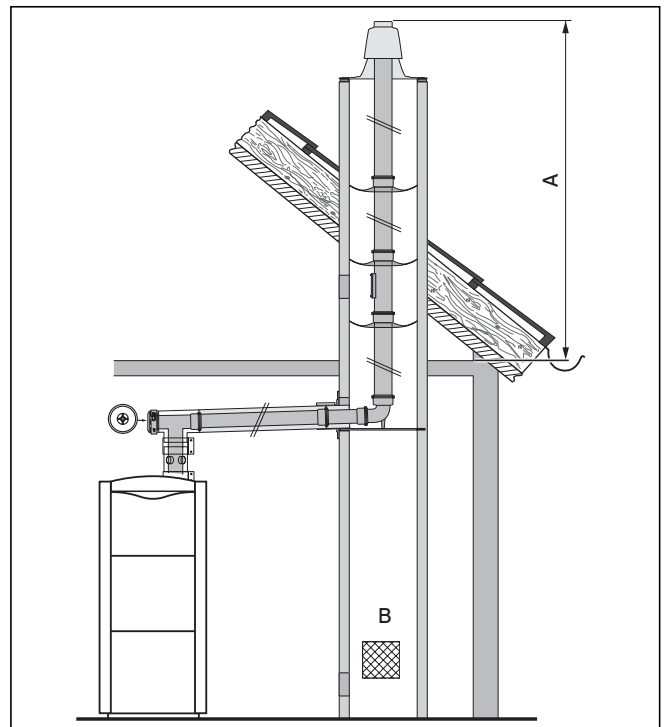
Пример монтажа с забором воздуха из помещения
